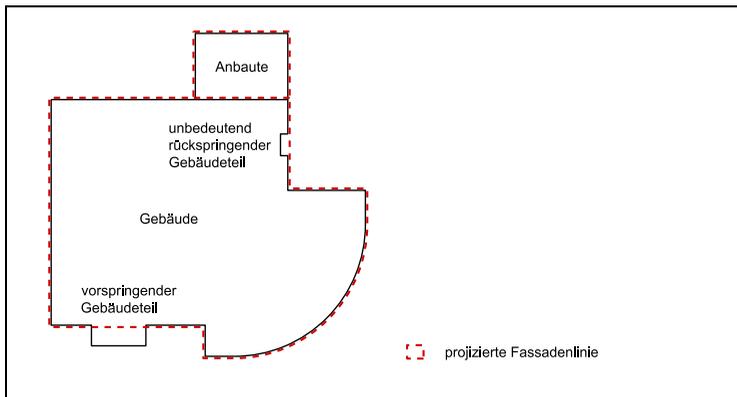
Gebäude, Kleinbauten und Anbauten (§§ 2, 2 a ABV)
